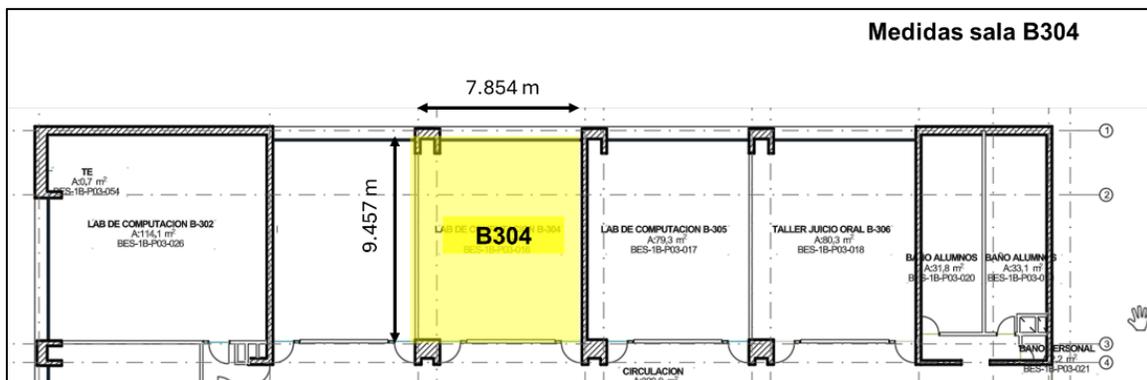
Dimensiones en metros sala B304 Sede Bellavista Sede Bellavista - AutoCAD
